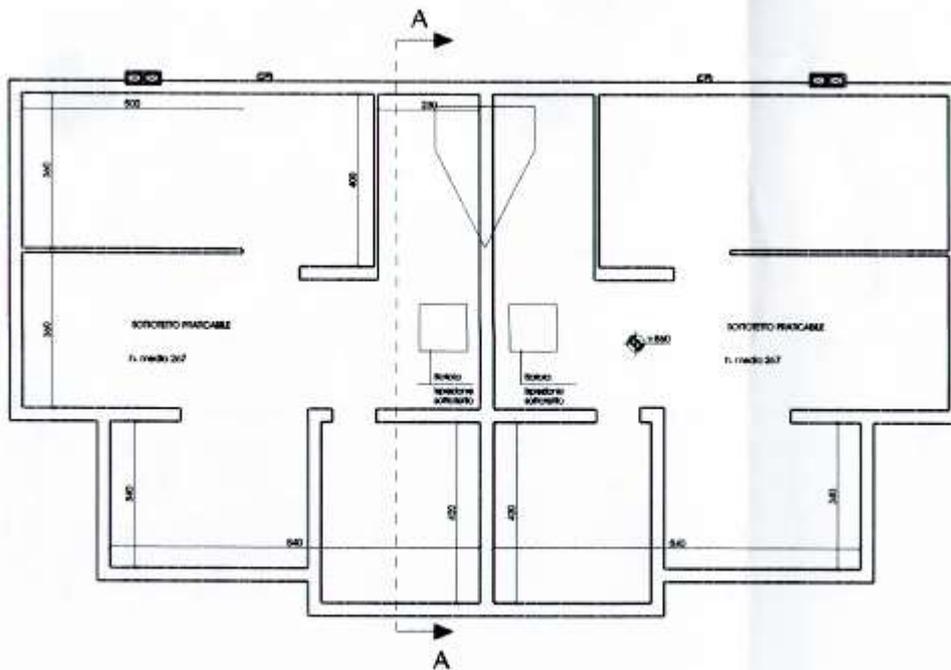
Planimetria Piano Secondo e Sottotetto Fabricato Pre esistente
